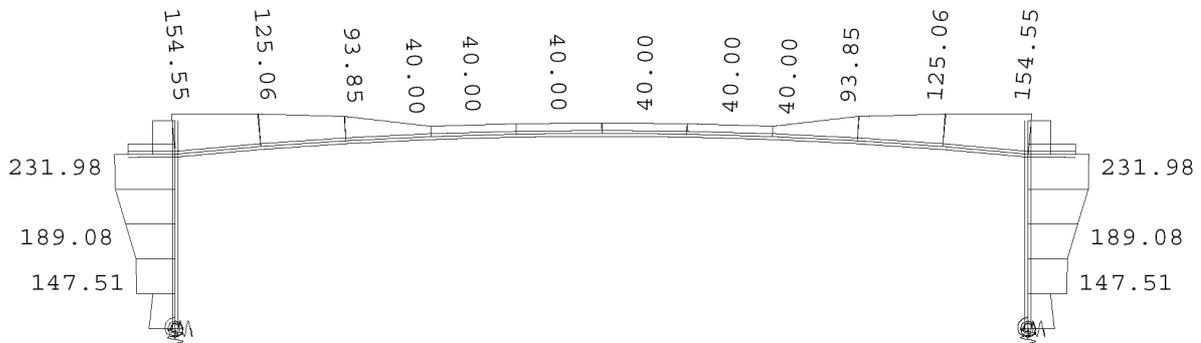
erforderliche Mindestbewehrung, Rang 2 („oben“ bzw. außen) erf A_s [cm²]
